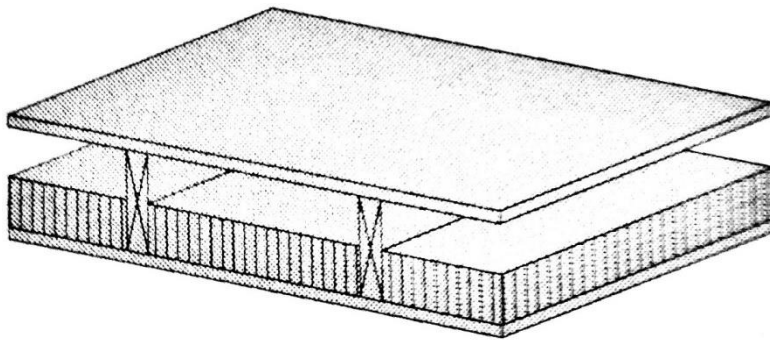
Skladba viditelné trámové stropní konstrukce (Kolb 2011)
